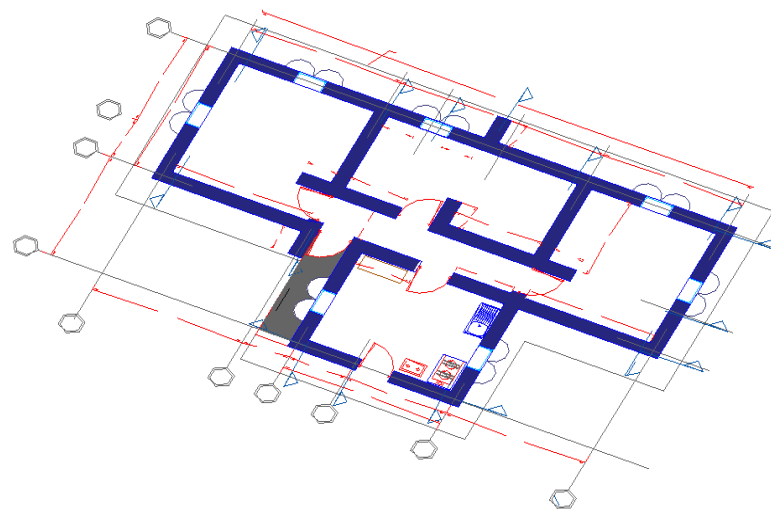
Vista de plano de cimentación de vivienda rural cinco personas
